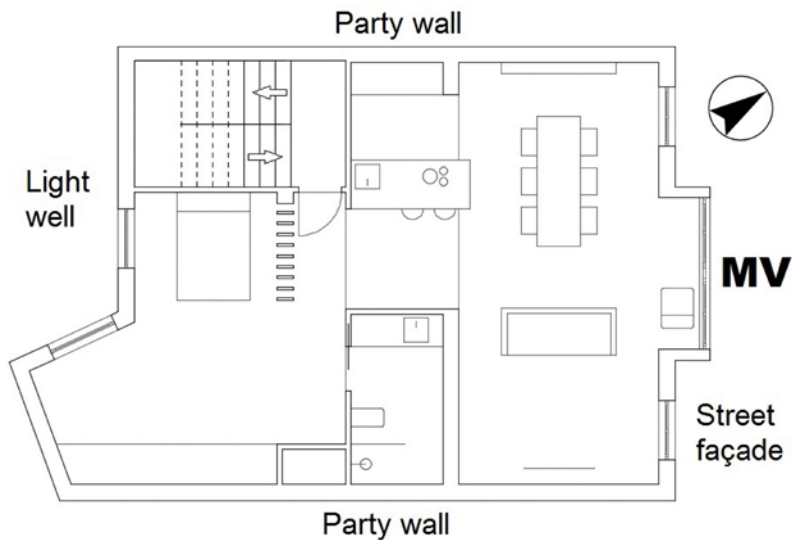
Detalle de la planta del apartamento del edificio considerado (Elaboración propia; 2017).
